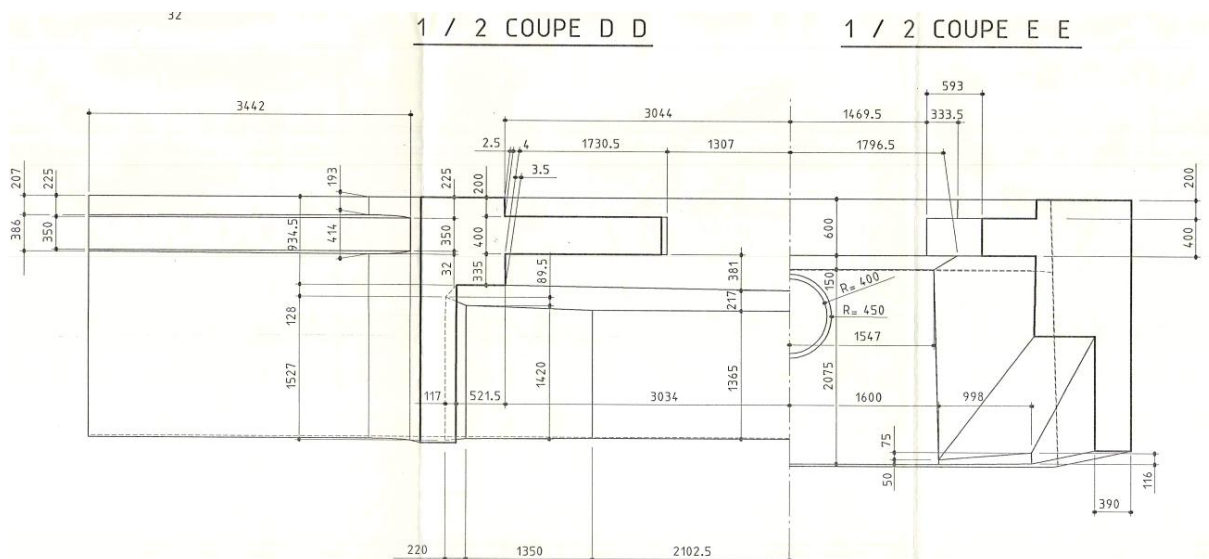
Coffrage voussiers sur pile (extrait plan P409)
